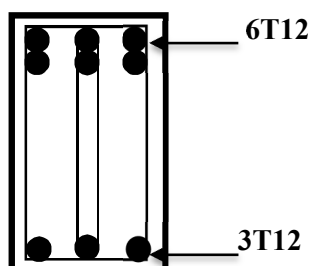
Dessin de ferrailage des sections des poutres Secondaires
